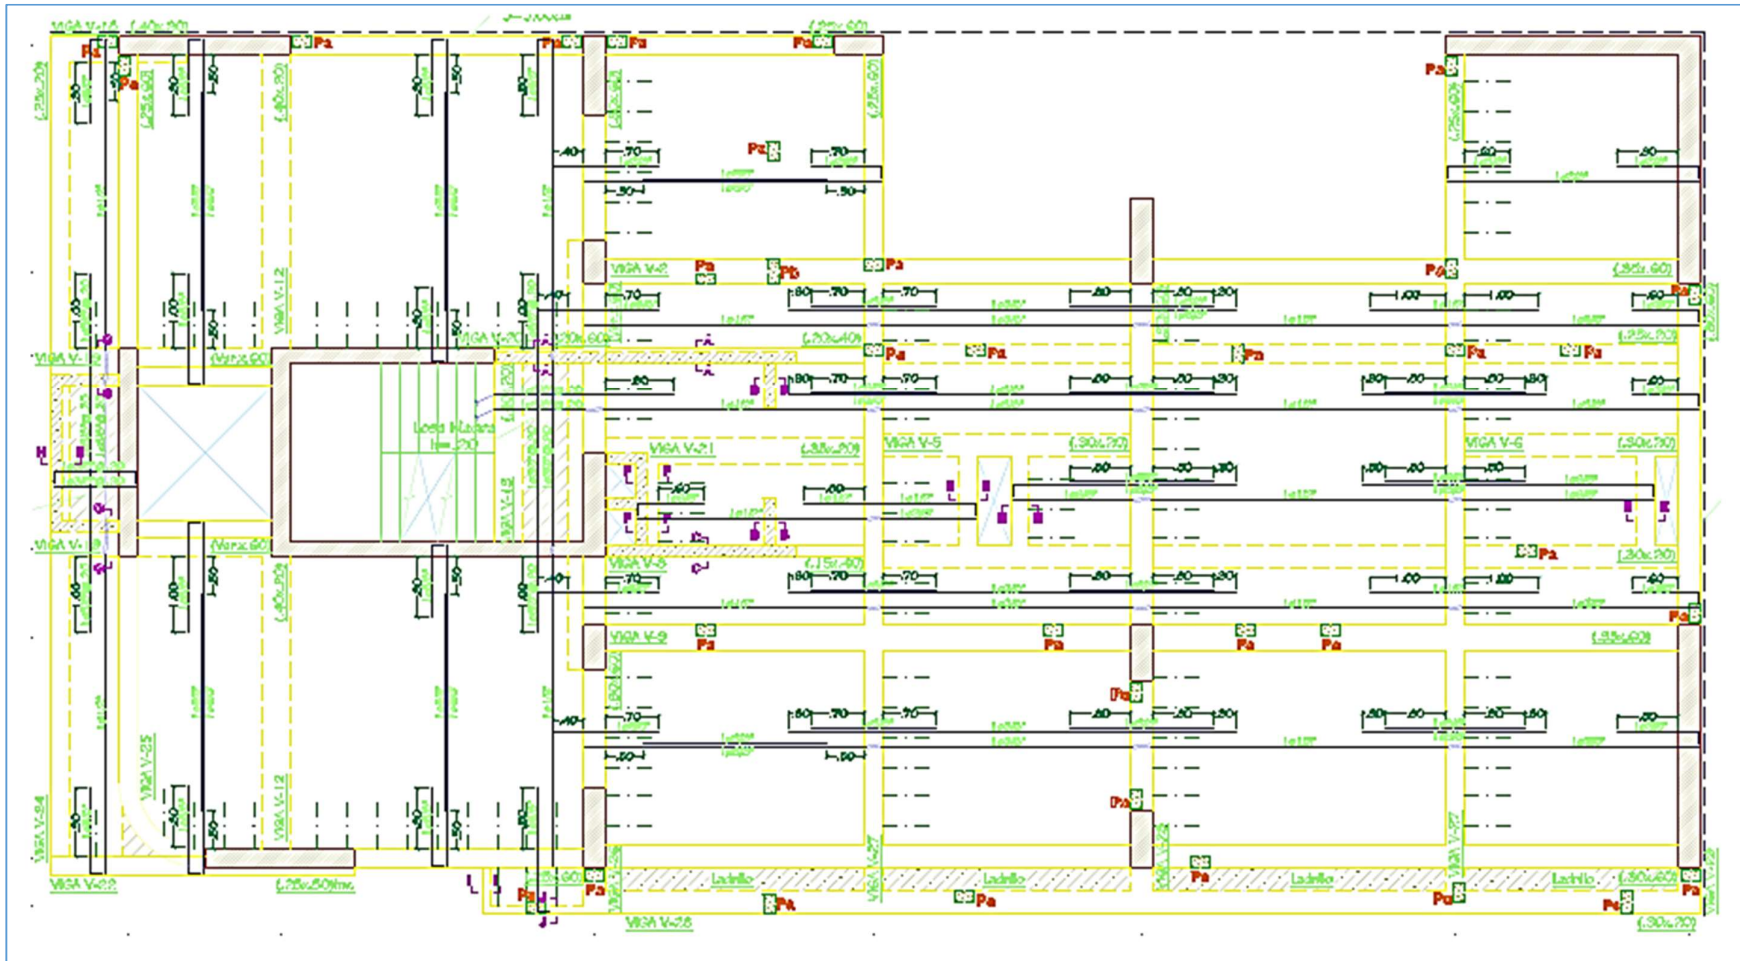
Plano estructural, planta típica (Fuente: Propia).
